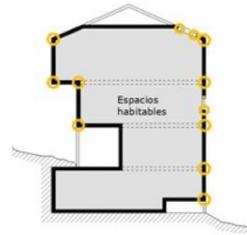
Análisis Caja de Persiana. Muro de Fachada Este. CE3X.
